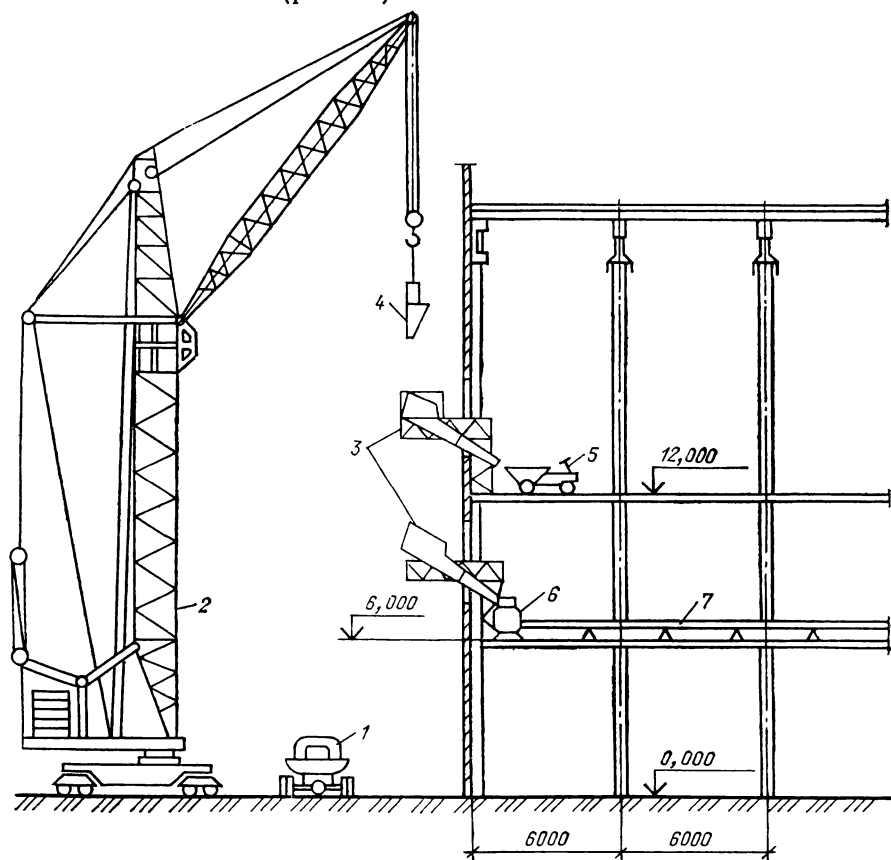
Схема бетонирования перекрытий при помощи башенного крана, вибропитателей и пневмоустановок в сочетании с мототележками:
